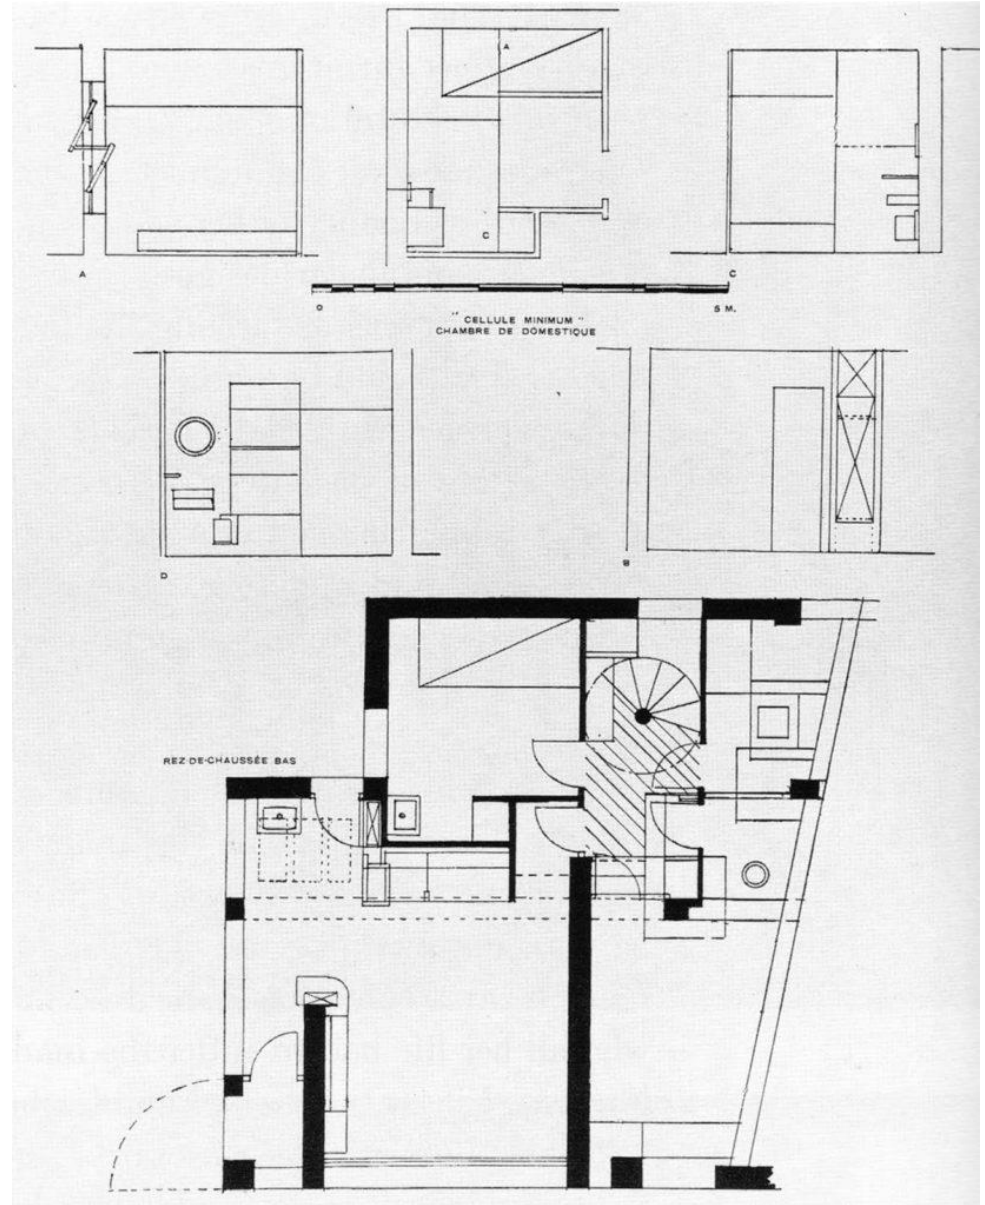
Planta baja y detalle de la zona interior. En la parte superior, alzados de la habitación de servicio, célula mínima de vivienda.
